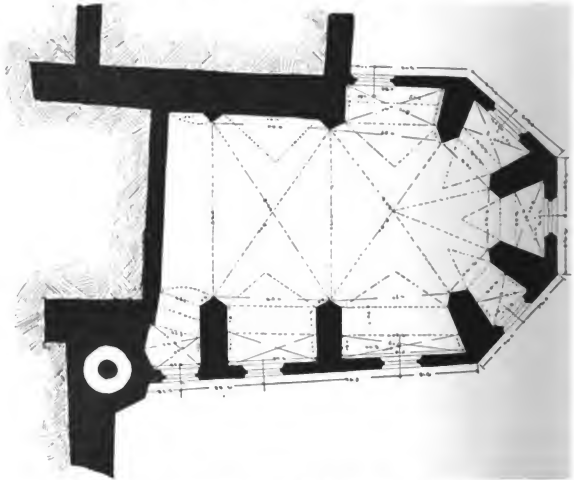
Meinic. Probsteikirche. Grundriss der Krypta unter dem Presbyterium.
